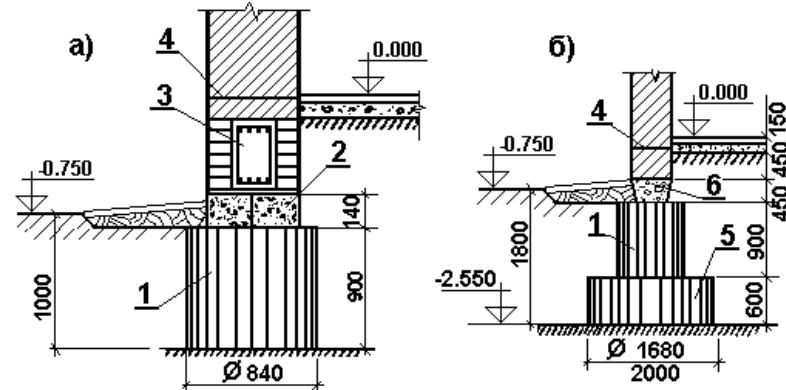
Столбчатые фундаменты на песчаной подушке в оболочке для малоэтажных зданий.
